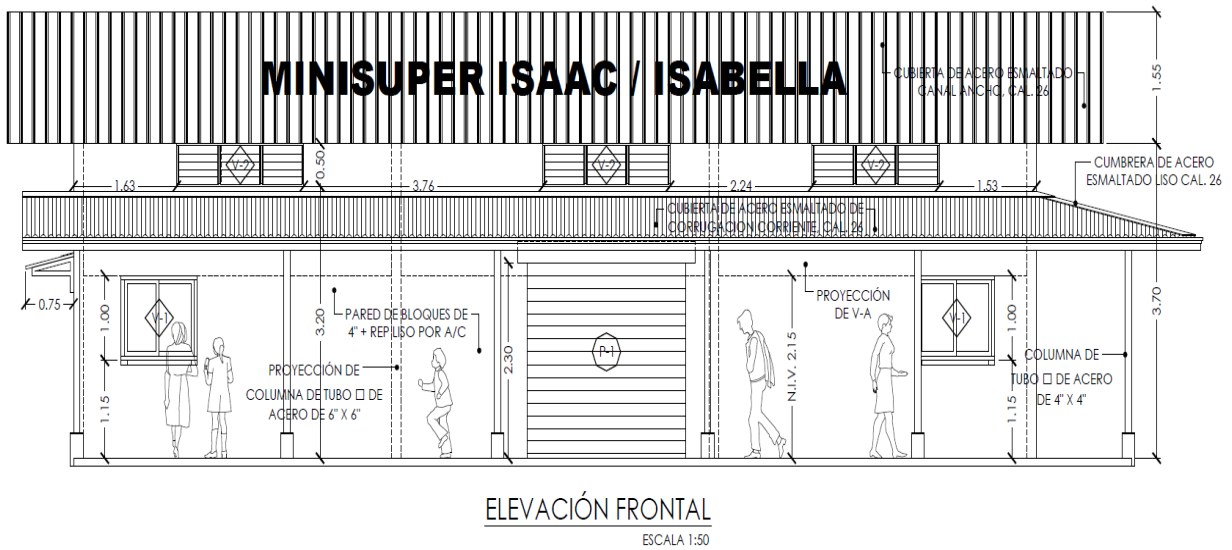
Detalle de elevación Frontal del Minisúper.
